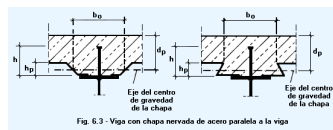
Viga con chapa nervada de acero paralela a la viga
